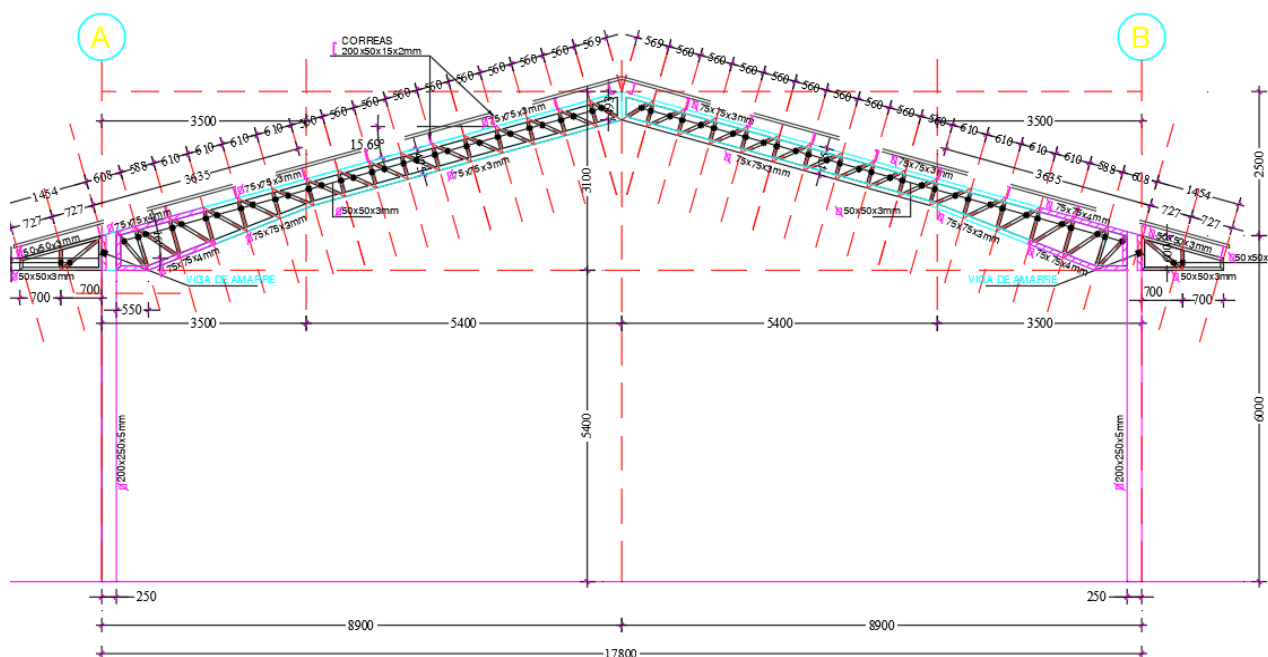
Dimensiones de viga de amarre y cercha tipo
